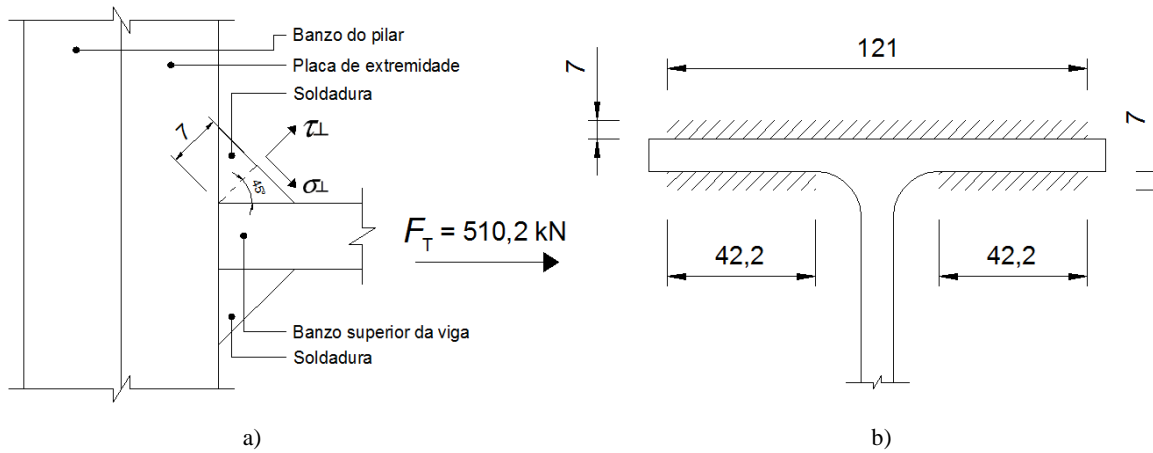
a) Corte longitudinal do banzo da viga. b) Corte transversal da viga (vista superior).
